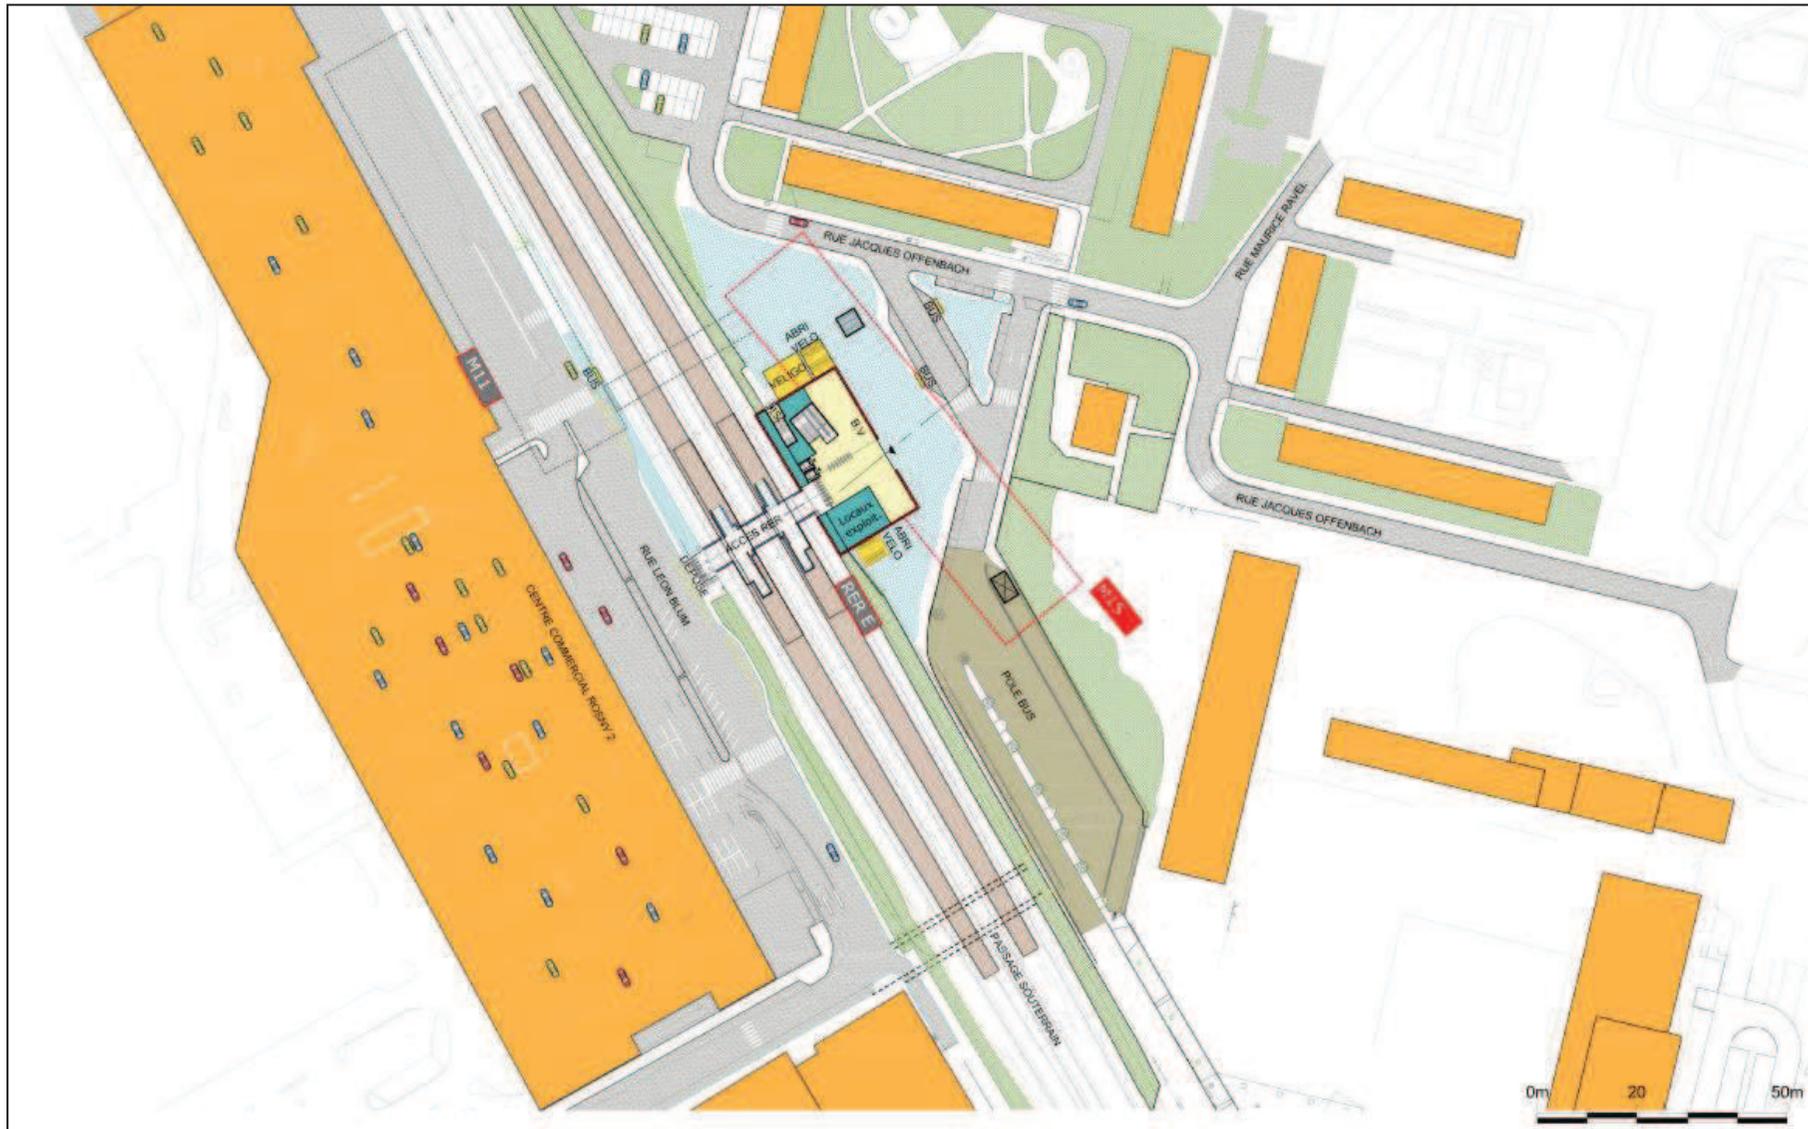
Vue en plan générale de la station Rosny-Bois-Perrier
